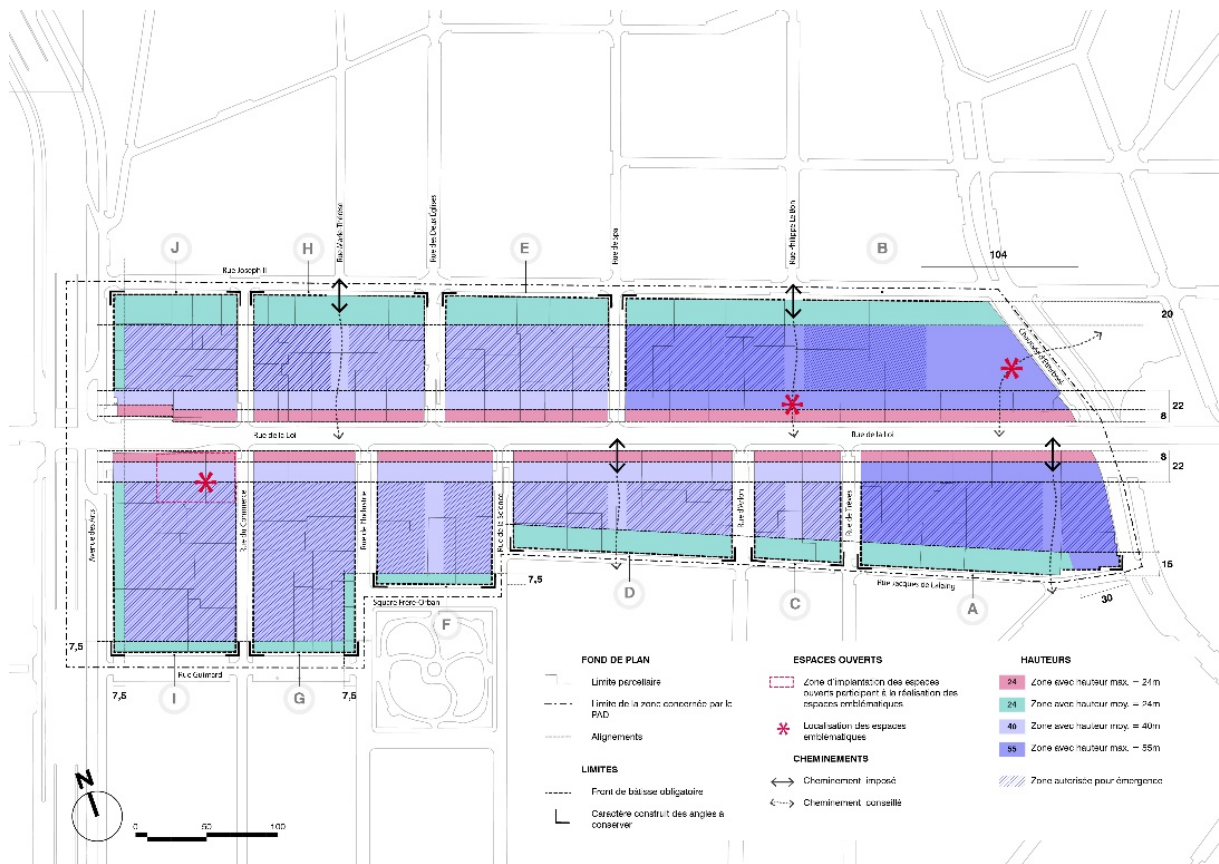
Plan d'implantation du projet de PAD (BUUR, 2019)
